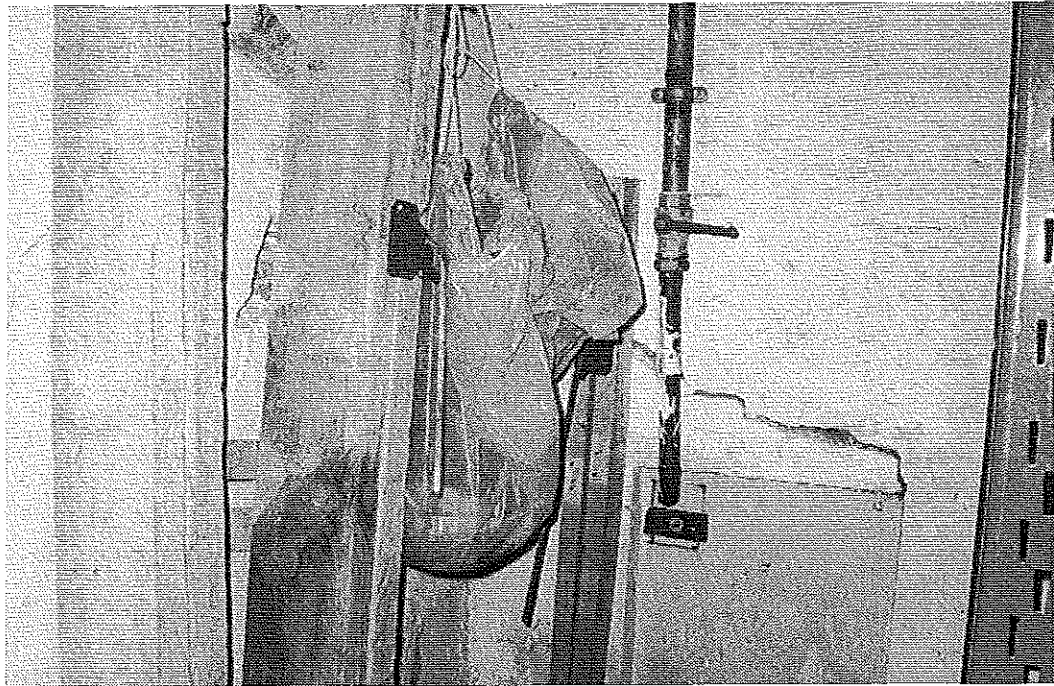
Fissuration sur façade (ouverture fissure > 0,01 m). © J. Putatti
